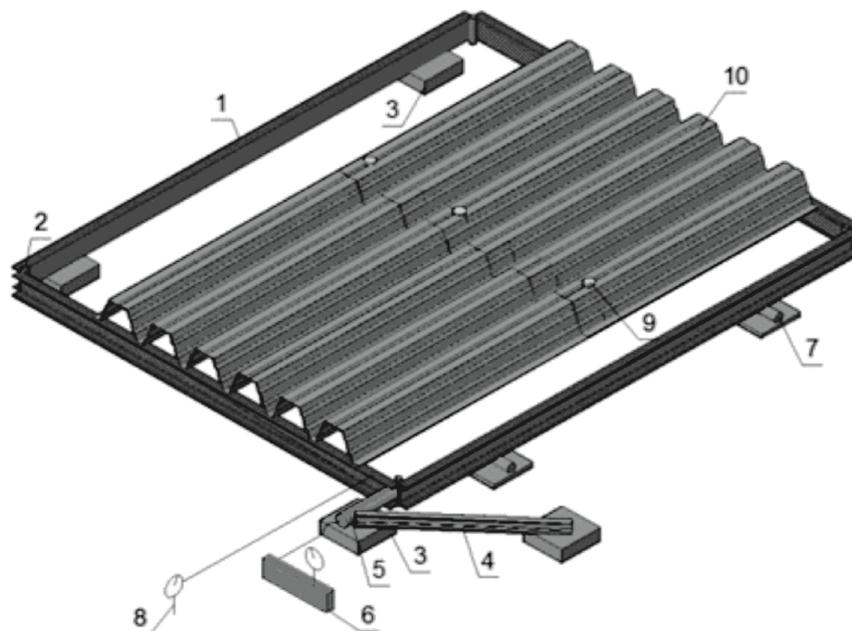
Схема испытательной установки: 1 – металлическая рама из четырех швеллеров; 2 – шарниры; 3 – жесткое крепление к силовому полу; 4 – упор; 5 – гидравлический цилиндр; 6 – насосная станция; 7 – катковые опоры; 8 – прогибомер дистанционного типа; 9 – индикатор часового типа; 10 – профилированный настил Н153-840-1.5
